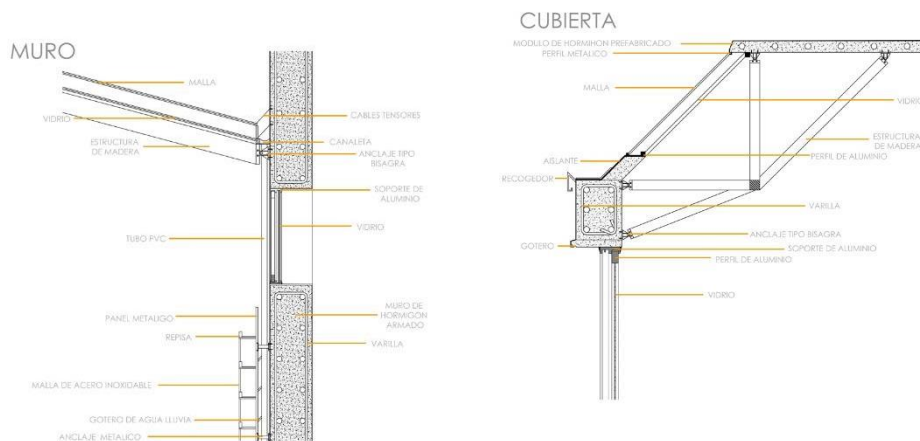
Detalles constructivos, muro portante (caja musical) y cubierta. Elaboración propia.
